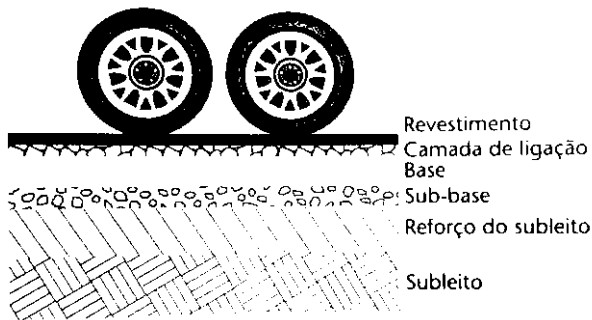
Camadas Genéricas de um pavimento (BALBO, 2007)
